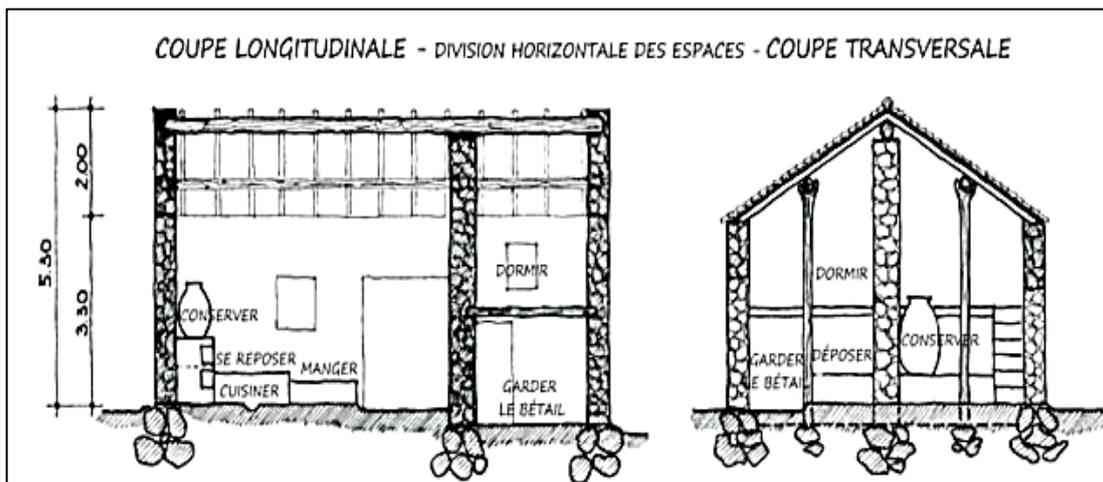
Coupe longitudinale et coupe transversale d'une maison de la *Qalaa* des bēni-Abbès montrant son système constructif (©association Gehimab, Béjaia)
